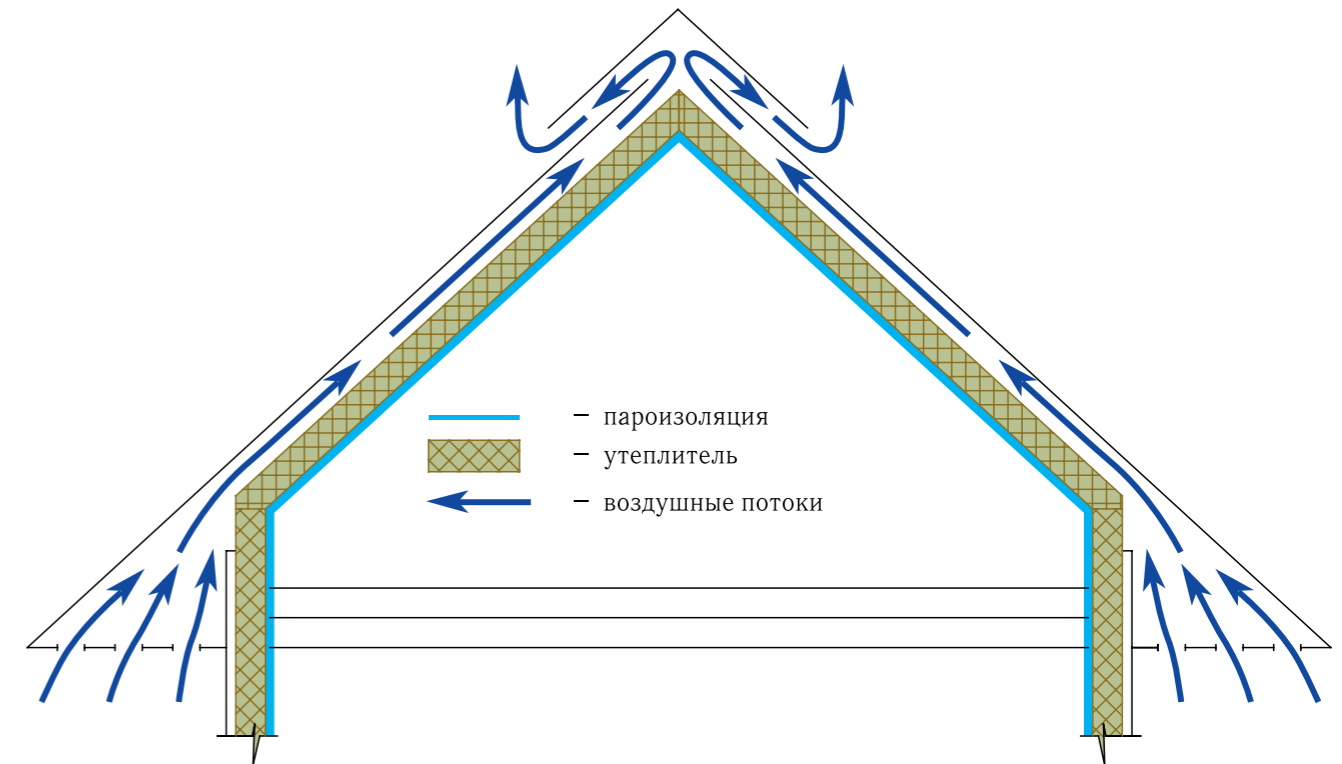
Схема утепления, пароизоляции и вентиляции мансарды
